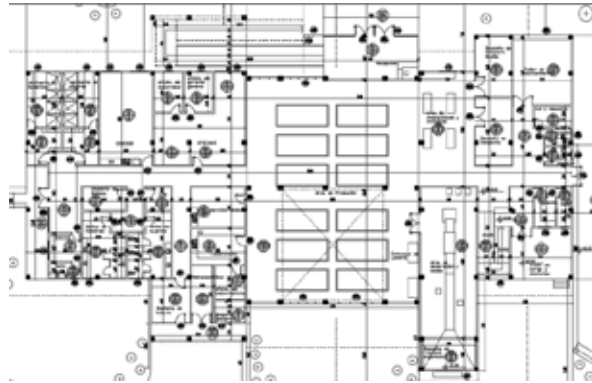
Acercamiento de la Planta Baja Nivel +0.15 m (2018)
